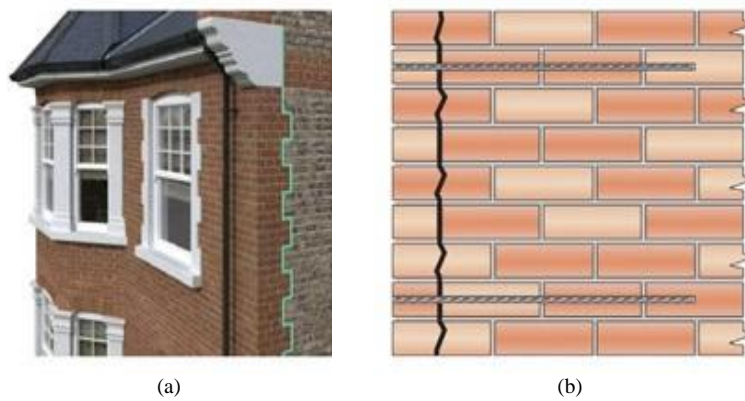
(a) e (b) Reparação de uma fissura numa parede utilizando armadura helifix
